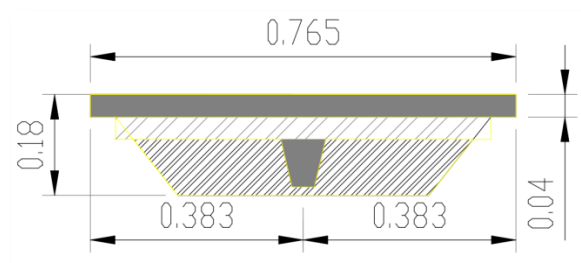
Sección Panel PL0765 (medidas en cm).
